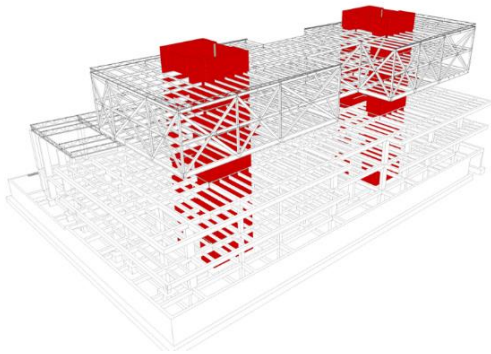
Axonometría Estructural- Tipo Núcleo
